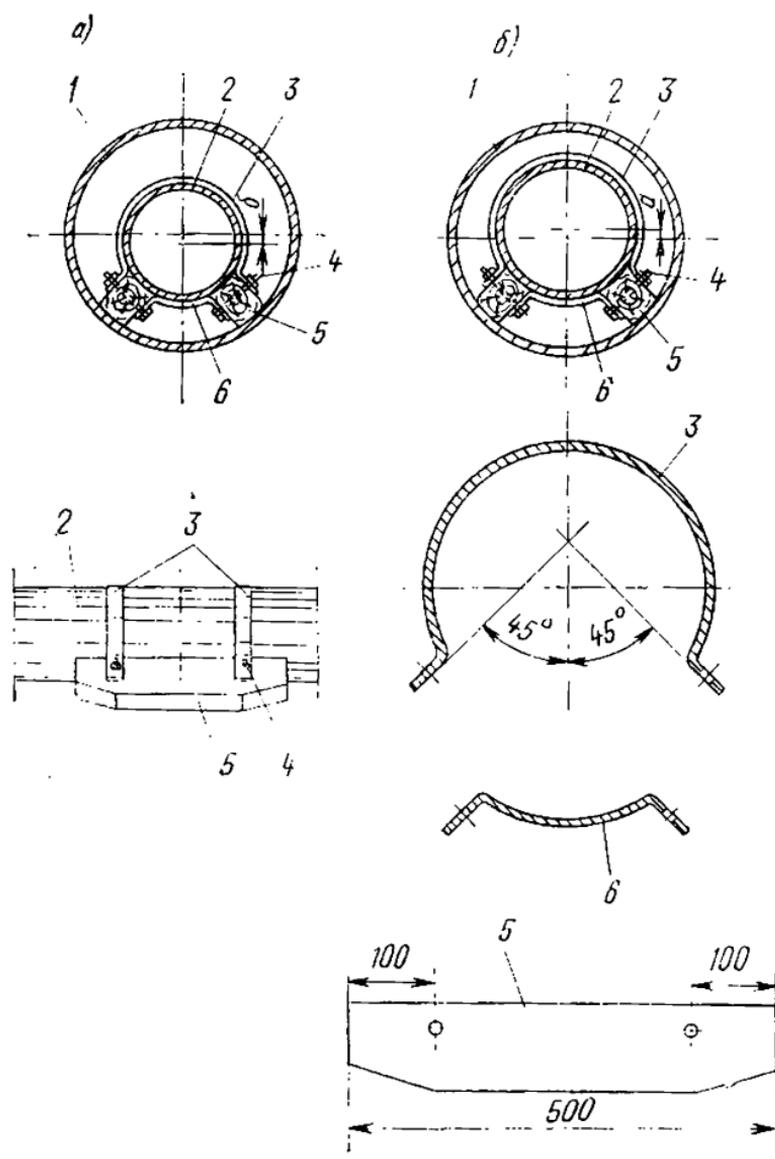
Опора с деревянными ползунками прямоугольного сечения
